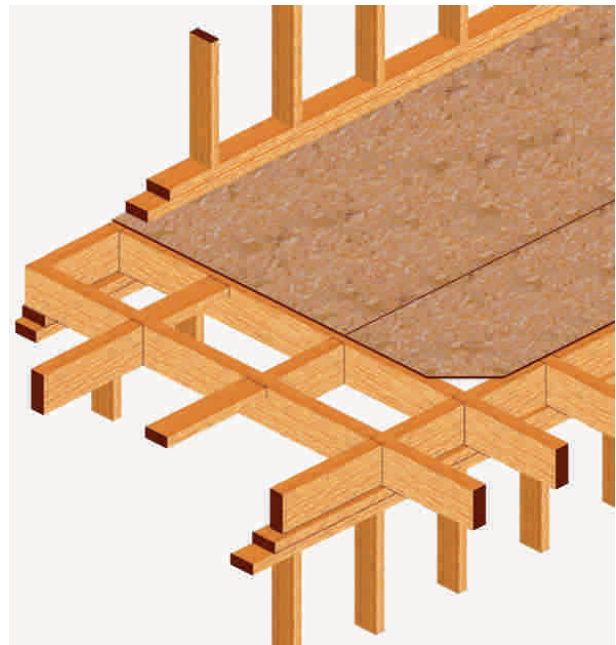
12: Elementos horizontales (vigas) apoyados sobre las soleras de amarre de los tabiques del primer piso. Arriostrando el entramado horizontal (plataforma de entepiso) con tableros contrachapado estructural.
